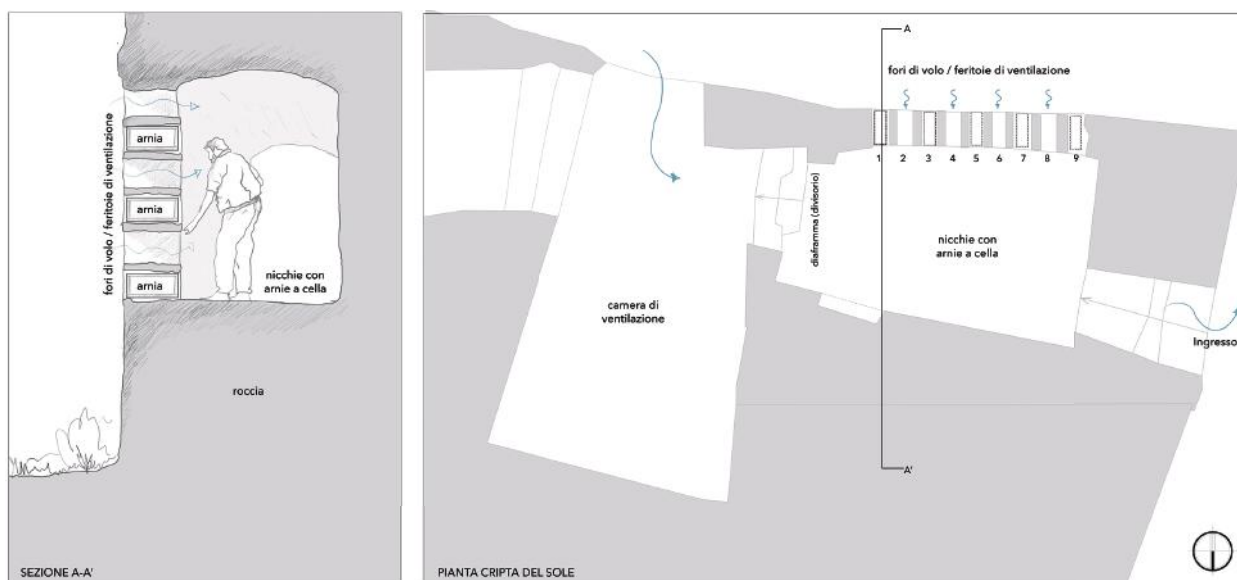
Matera, Grotta del Sole, pianta e sezione dell'avucchiara
